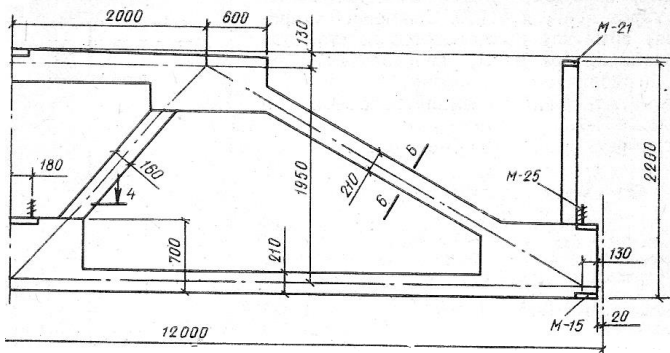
Подстропильная железобетонная ферма для скатных покрытий
